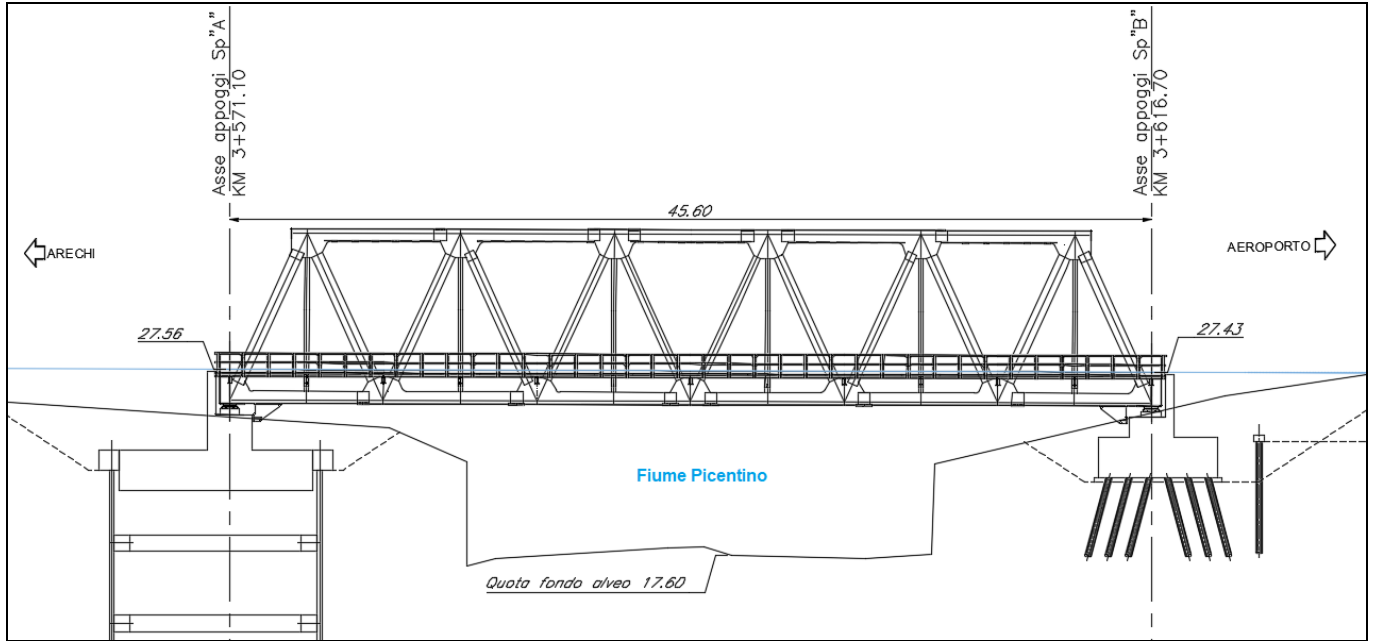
Viadotto VI02 sul Fiume Picentino: prospetto.
